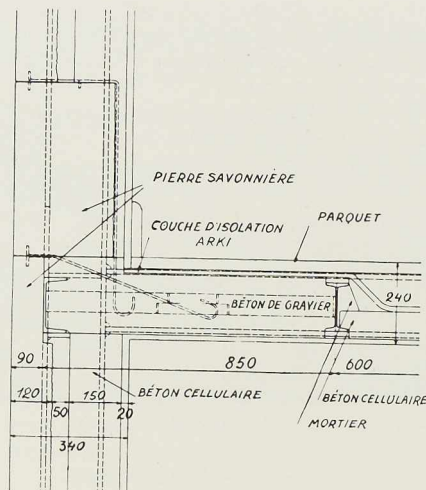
Coupe à travers un mur de façade et un hourdis de plancher du bâtiment Bel-Air Métropole à Lausanne. L'épaisseur des murs de façade est constante et égale à 340 mm, sur toute la hauteur du bâtiment.
